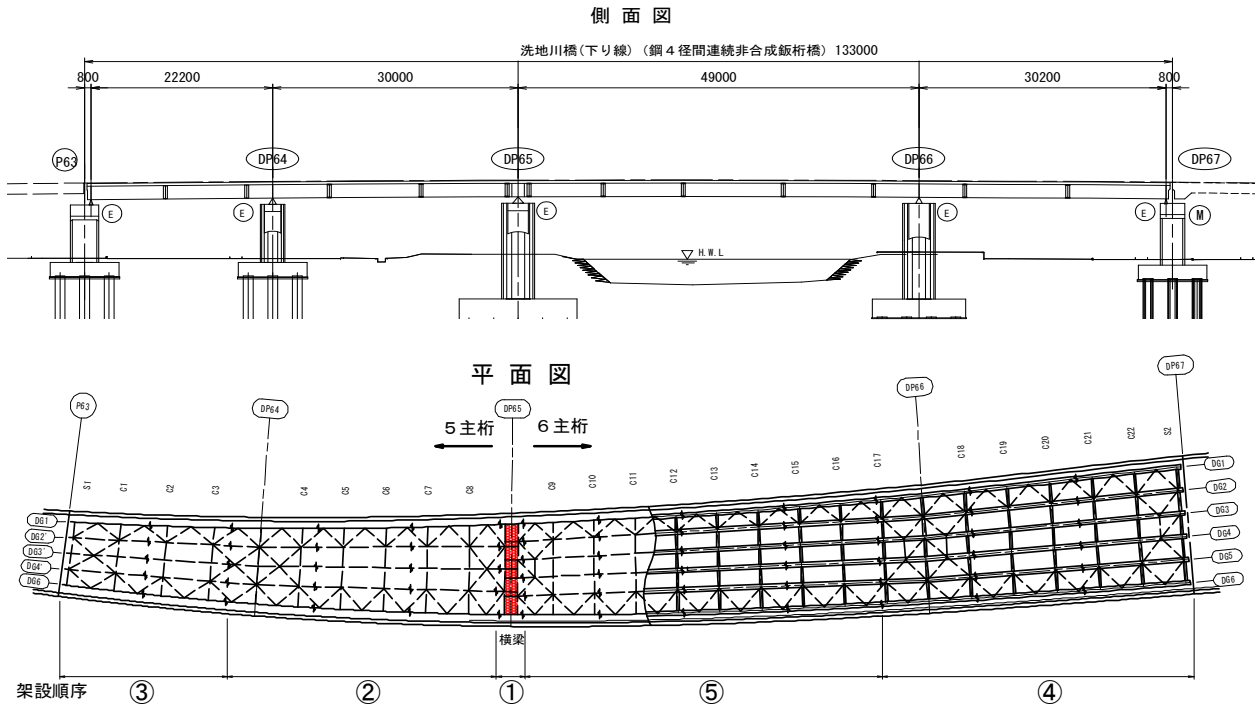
洗地川橋（下り） 上部工側面図（上）, 平面図（下）
